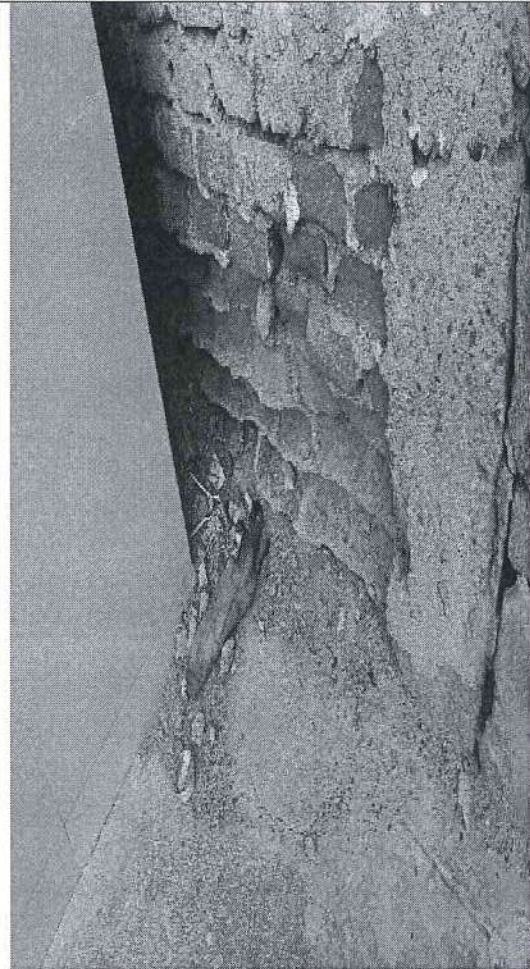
Parte inferior del muro carcomido por la humedad de las lluvias
